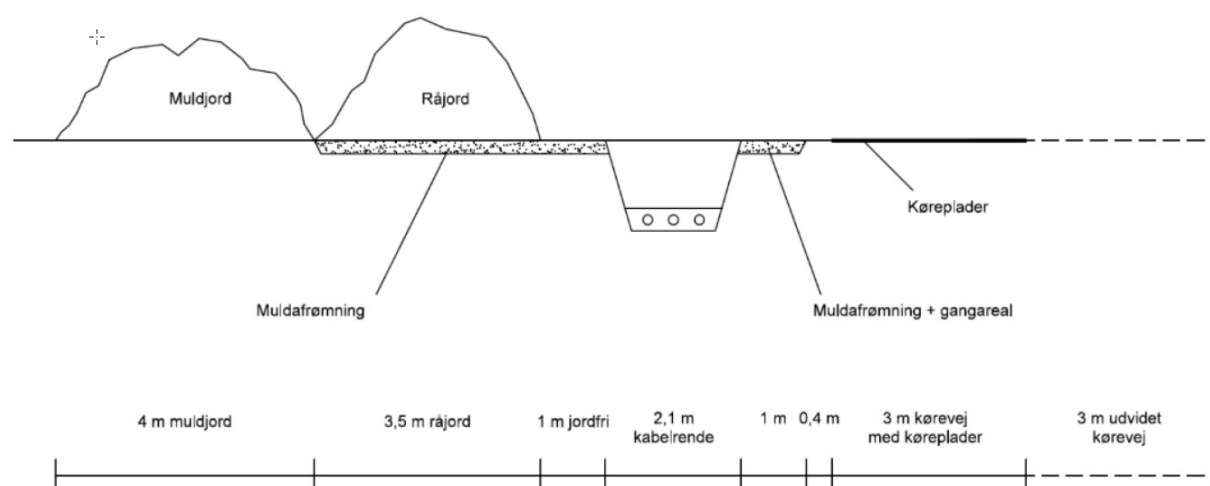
Krydsning ved Fiskbæk Plantage, Mast 162-163
